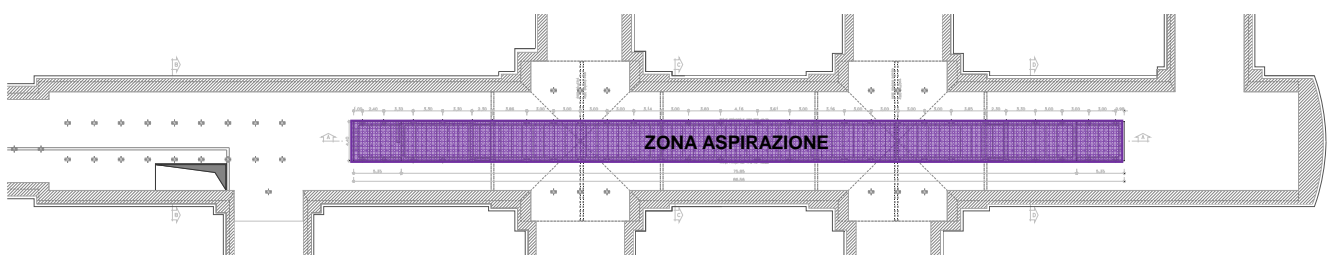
pianta terzo solaio (copertura passaggio pedonale)
